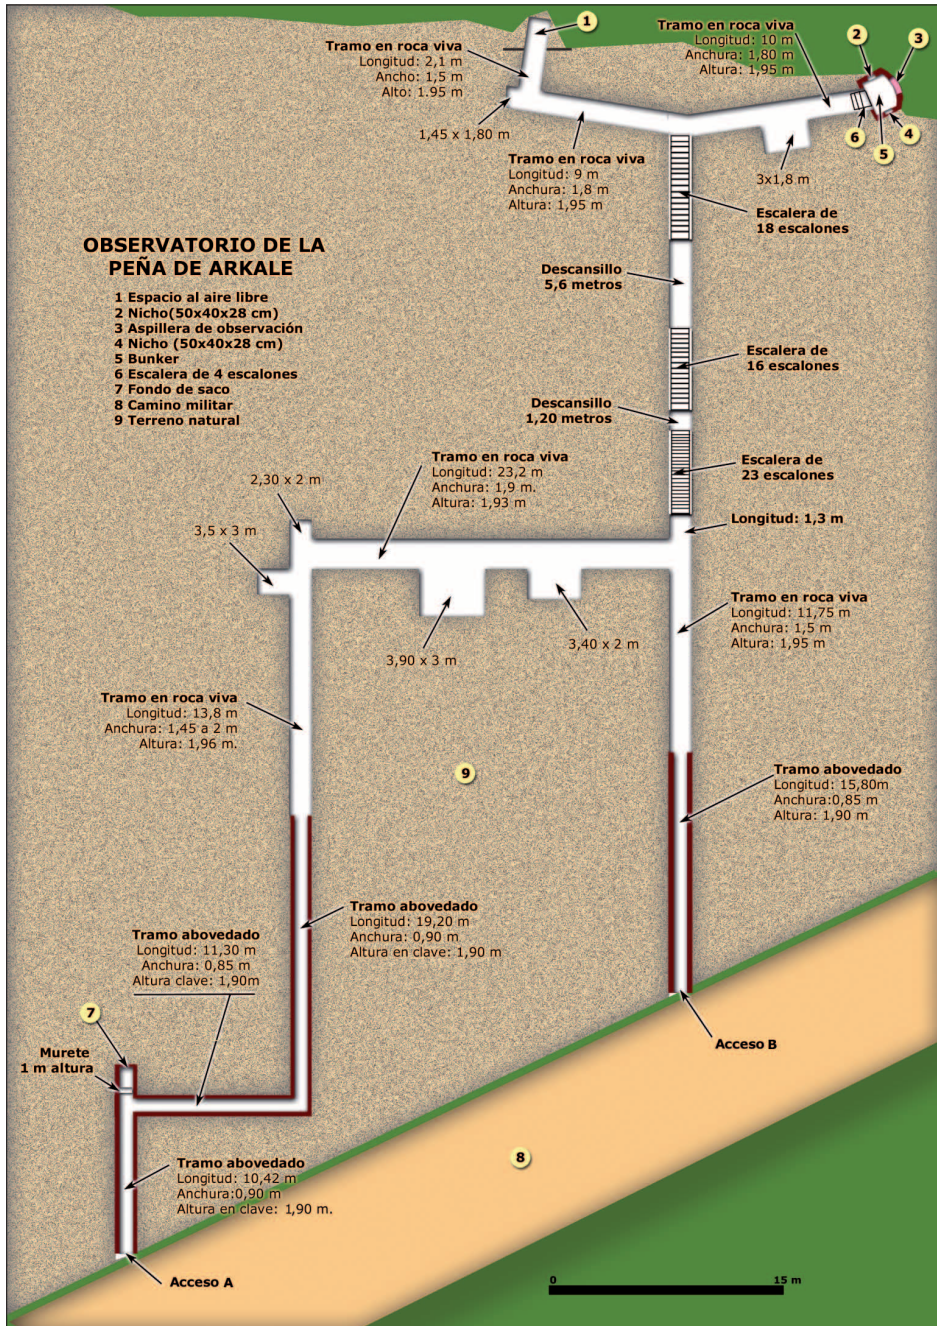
Observatorio de Arkale. Planta del estado actual.
